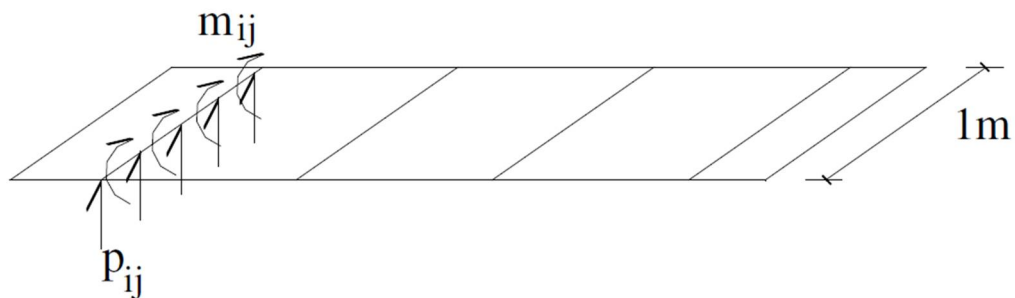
Faixa unitária de laje (STUCCHI, 2006)
